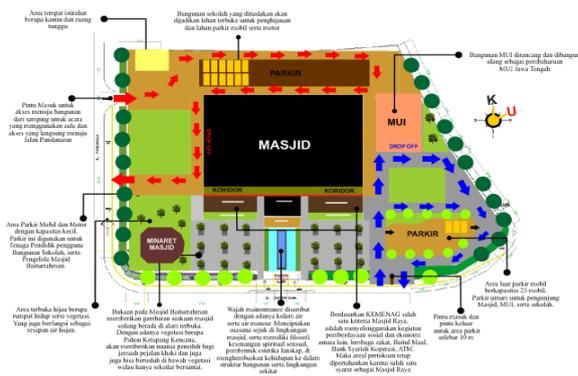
Analisa Fungsi Bangunan Pada Siteplan
